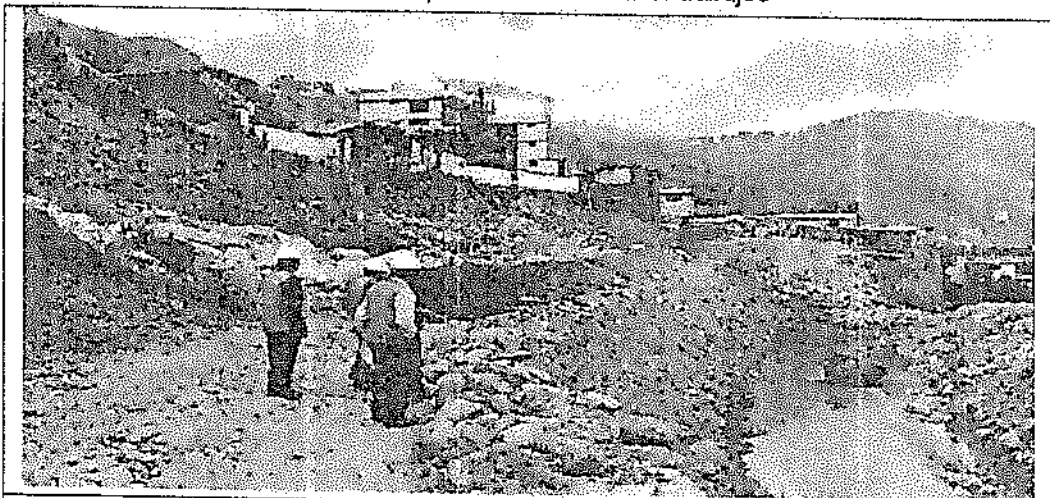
Tramo del sector II donde será colocado el muro de concreto y que requiere absolución de consultas para su continuidad.
